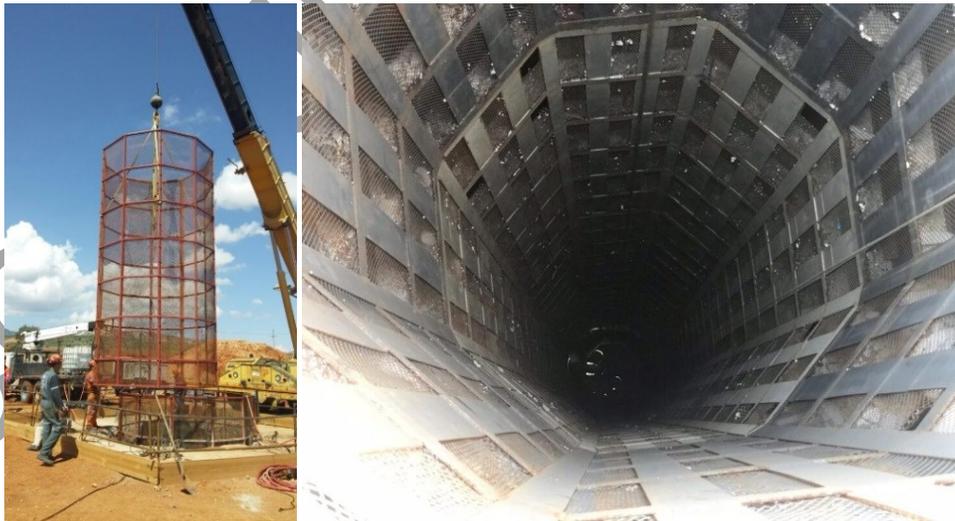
Esquema de la perforación del contrapozo de ventilación.
